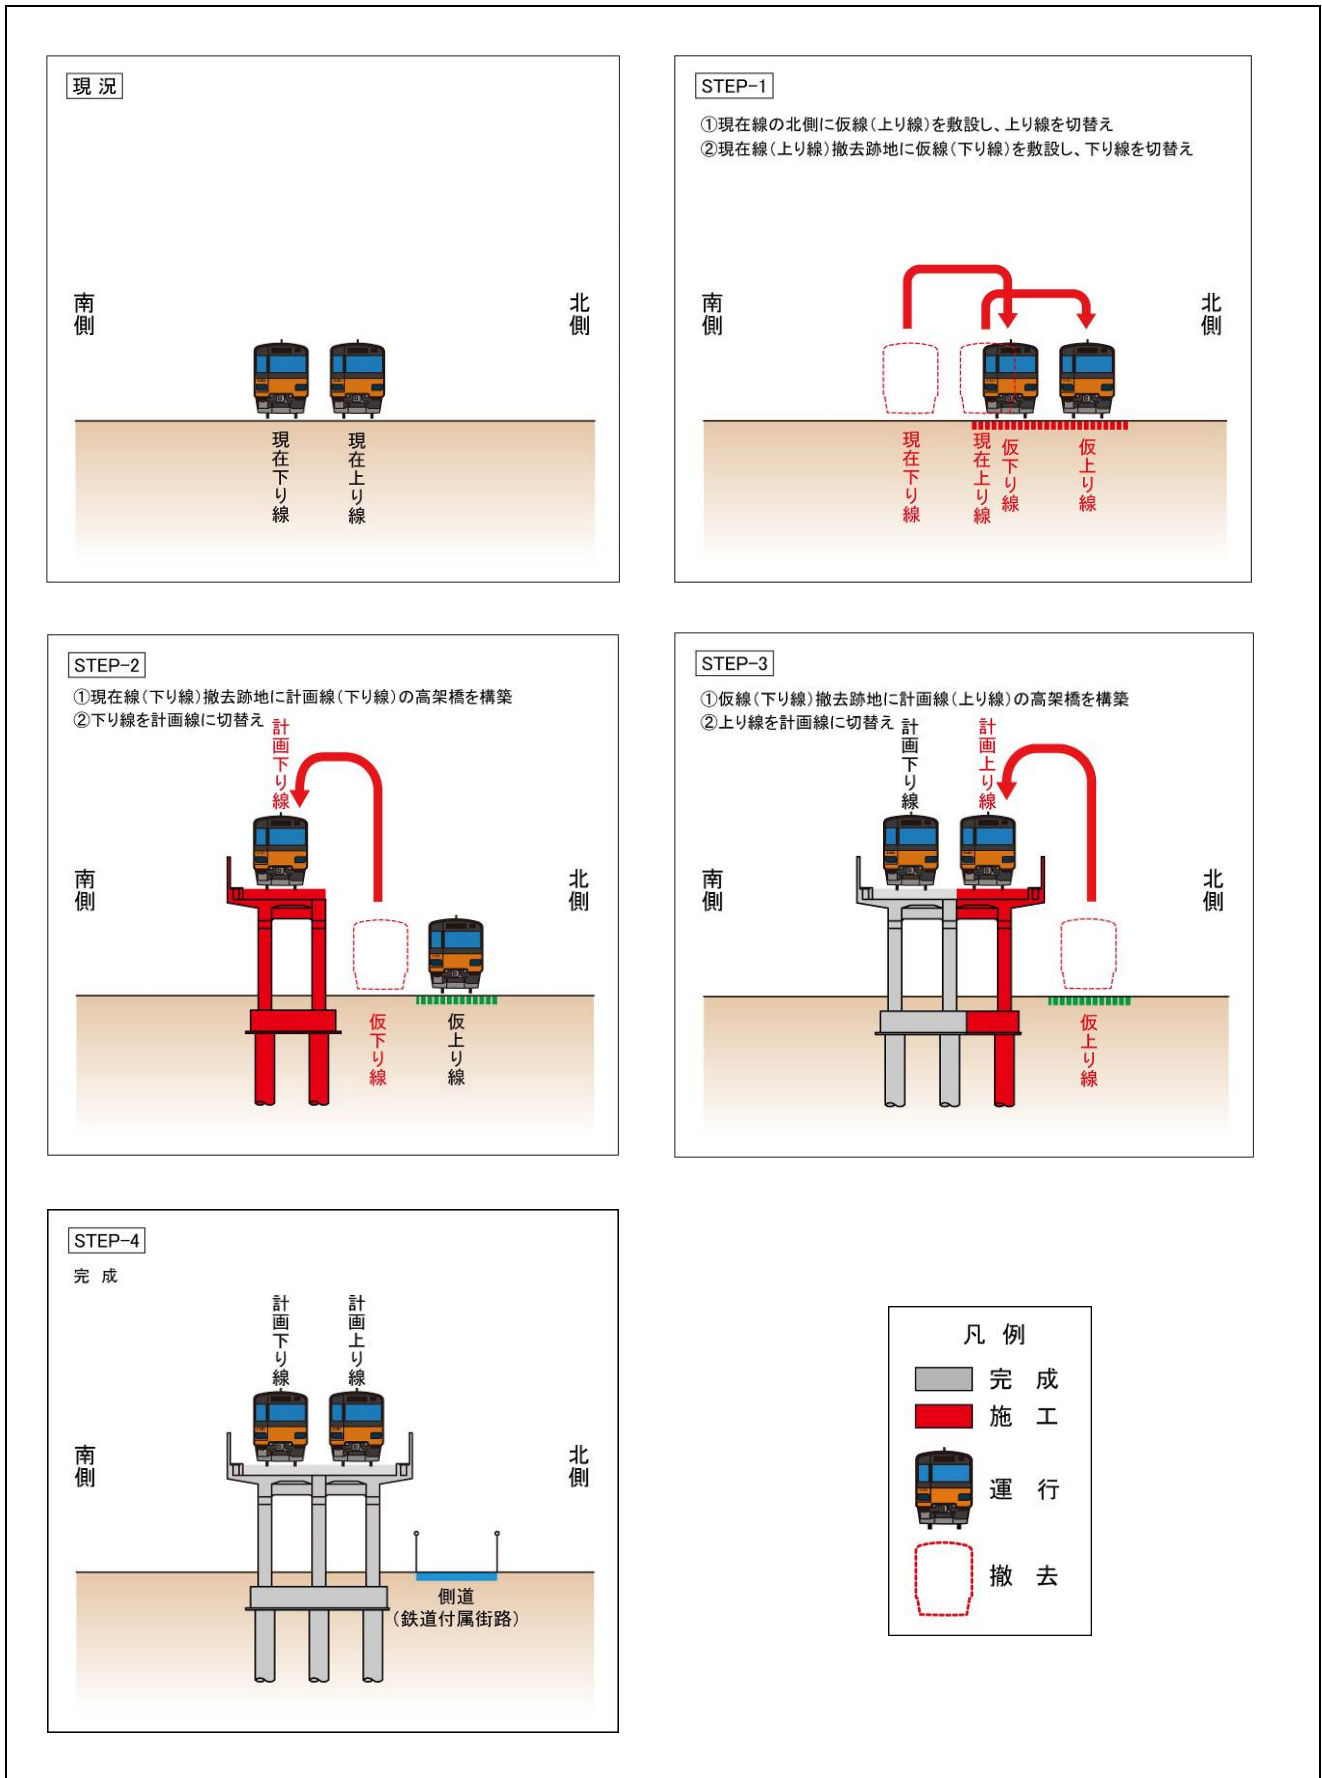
施工順序図(一般部 高架橋区間)
